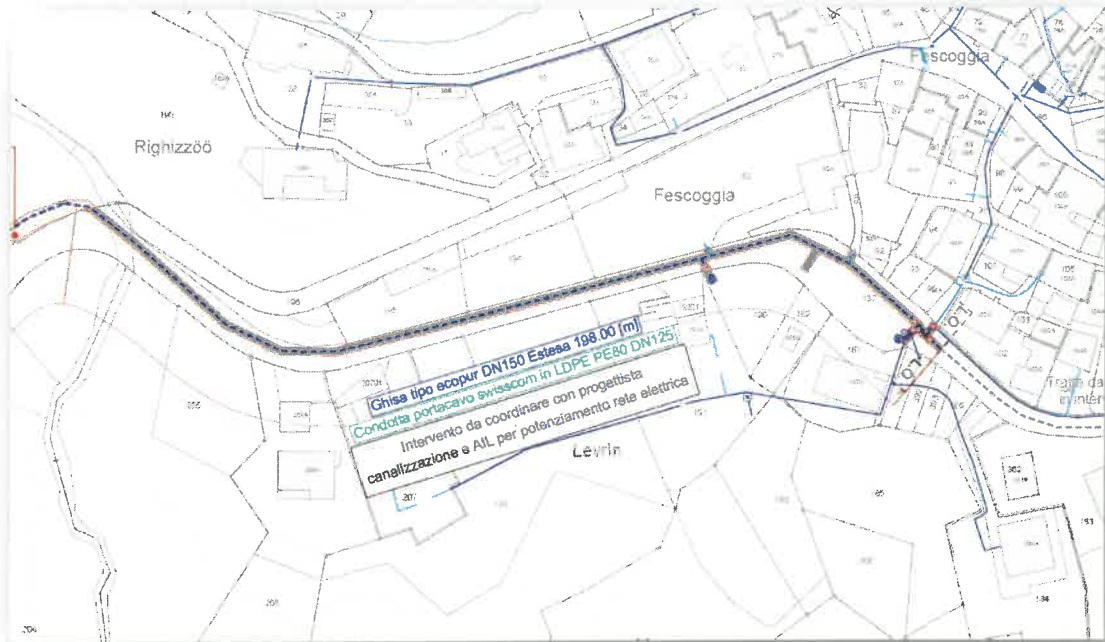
Stralcio planimetrico con individuato il tracciato su bosco per l'intervento 3
